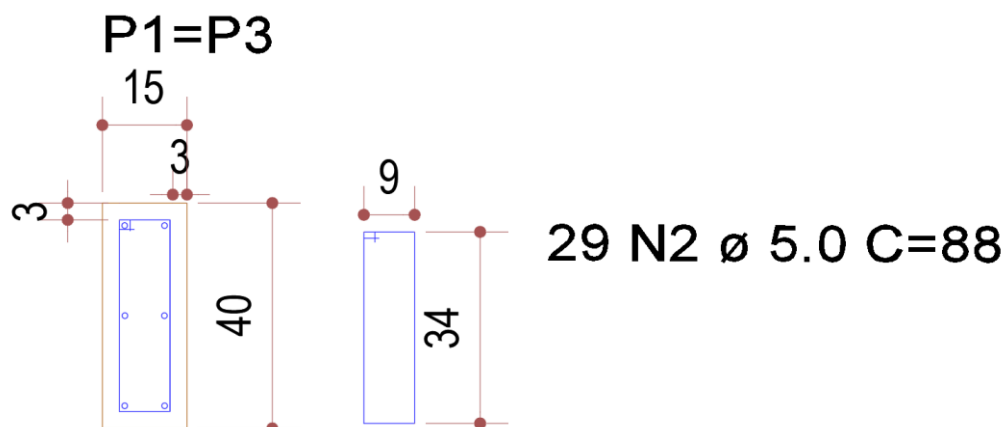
Armaduras Longitudinais e Transversais Pilar 1 e Pilar 3
